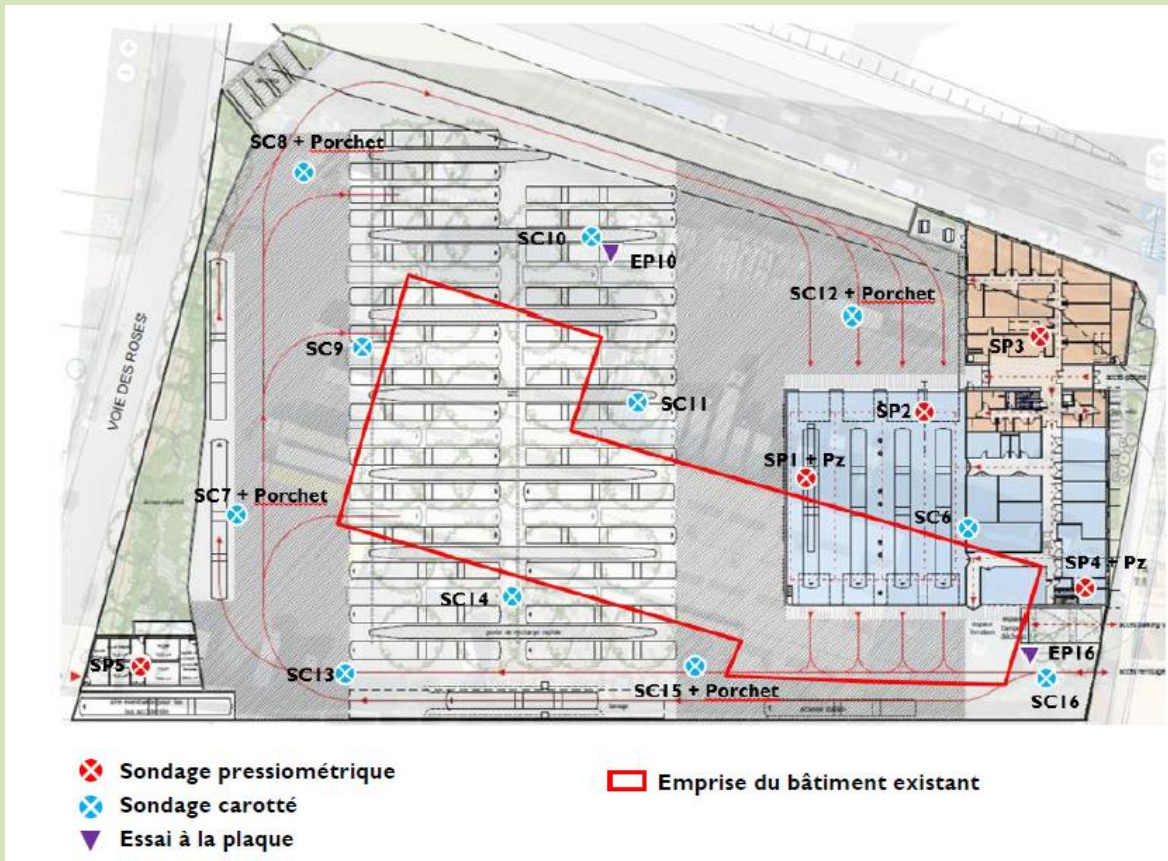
Plan d'implantation des piézomètres SP1 et SP4 (Etude géotechnique G1+G2 AVP, Fondasol, 2020)
